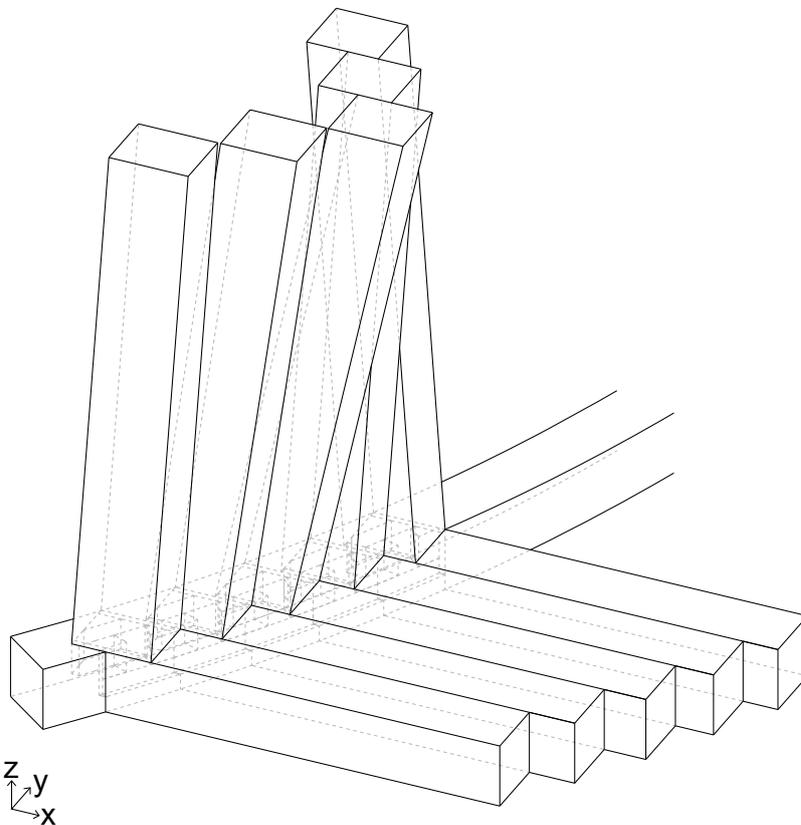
Modèle de plancher en bois équarri et une poutre arrondie
